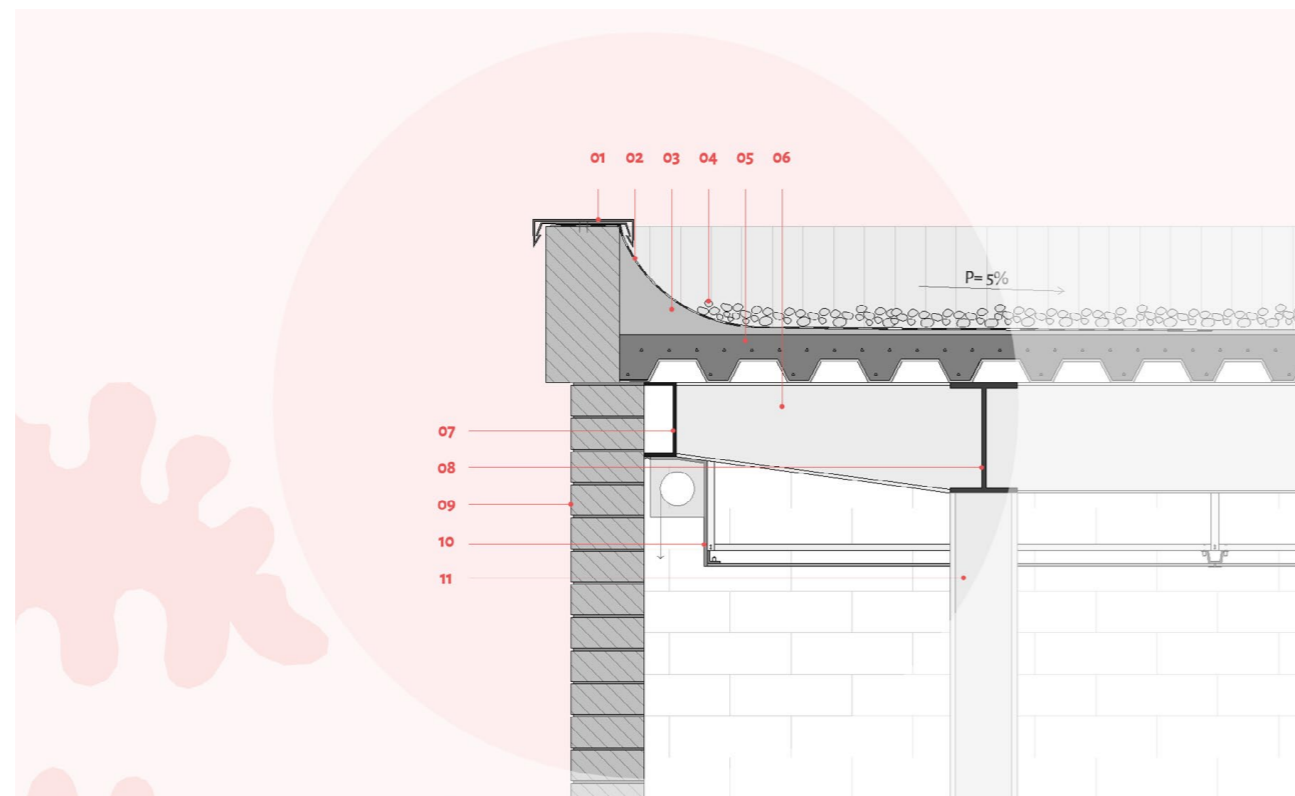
Detalle Constructivo 01 Fuente: Elaboración Propia
